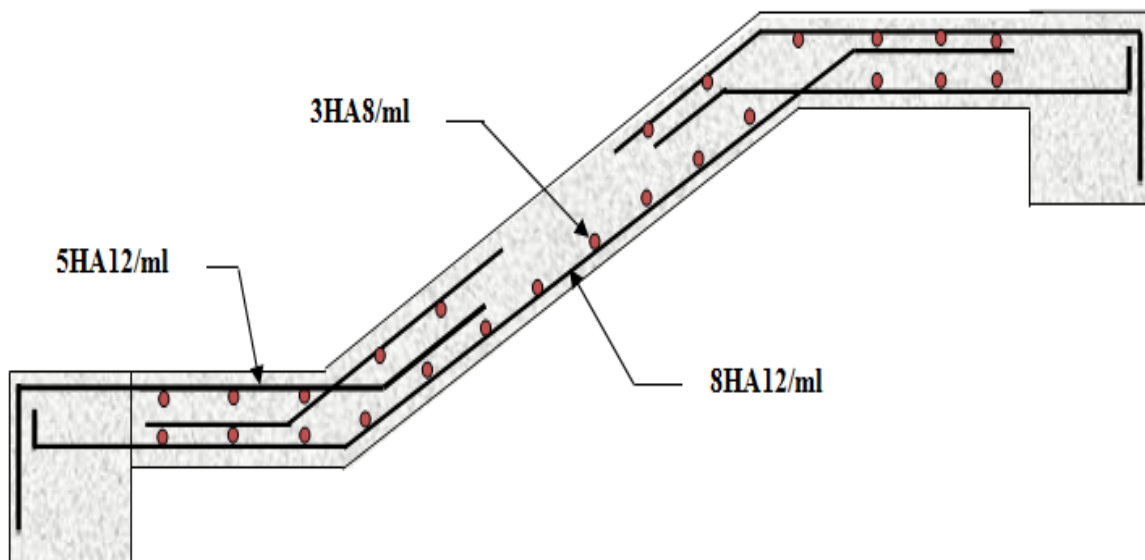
Schéma de ferrailage de l'escalier type 1 et 2
